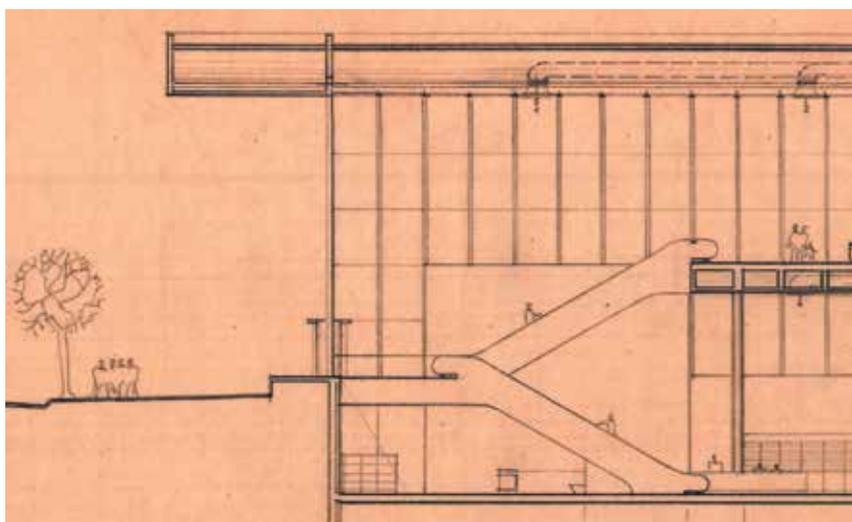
AROZTEGUI, CNAD (ANTEPROYECTO, 1957). CORTE TRANSVERSAL, DETALLE. CDI-IHA, PL. 11816.
